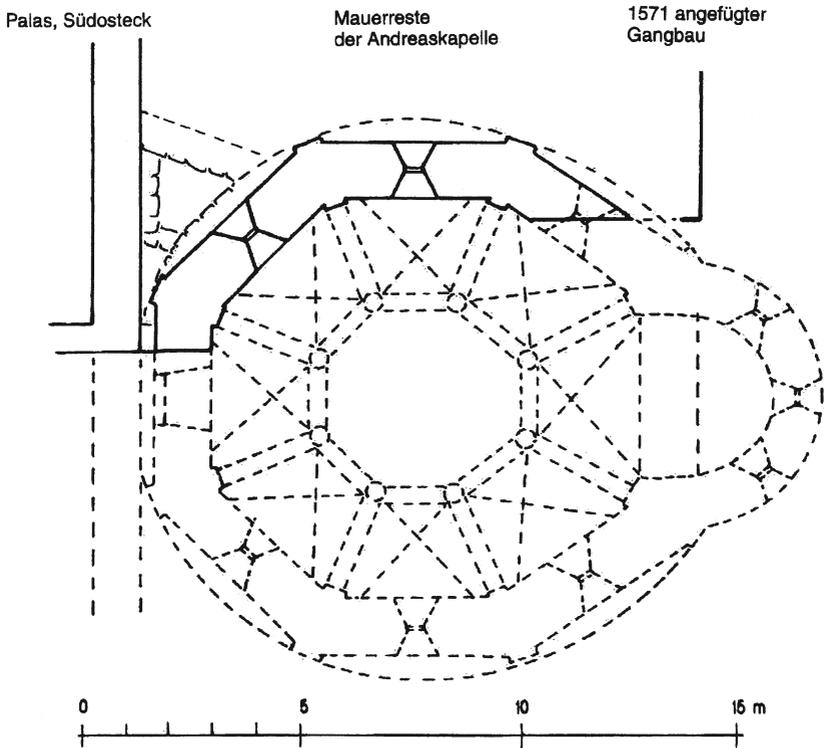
Bamberg. Ergänzier Grundriss mit Rekonstruktionsversuch für einen inneren Säulenkrantz und der Deckenkonstruktion (nach Burandt 1998, 143 Abb. 144).
